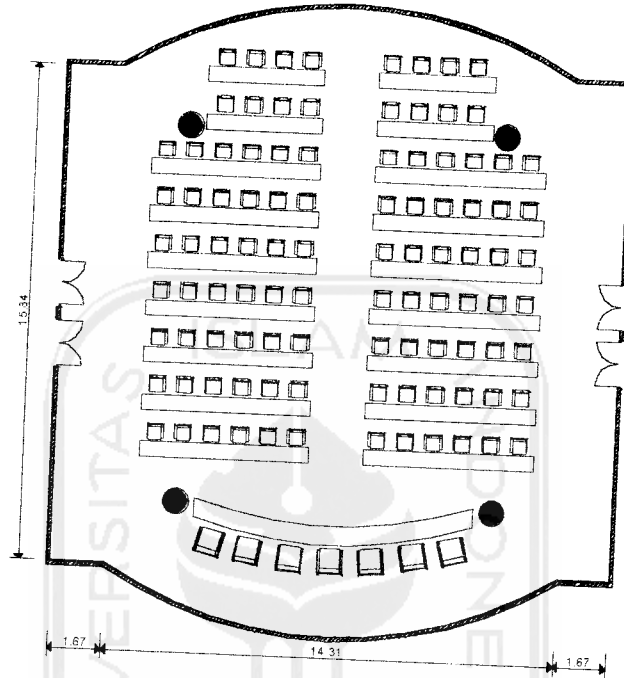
Layout Potongan Ruang Galeri Penjualan dan Pameran
